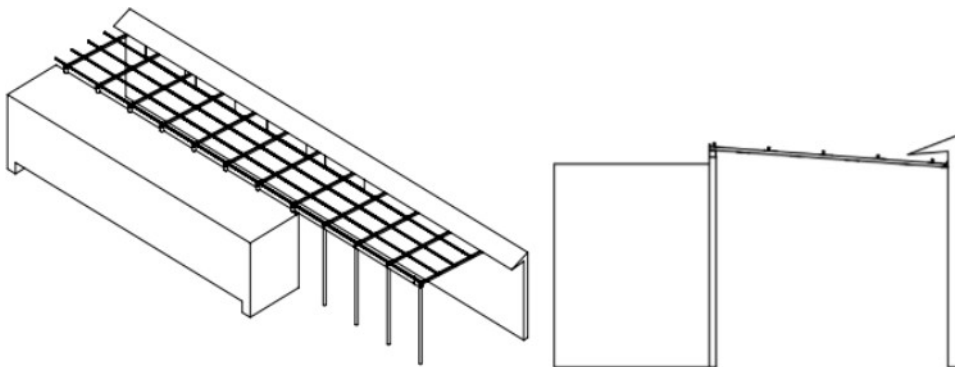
Desenho da estrutura de suporte para captação de água e placas fotovoltaicas (esq. perspectiva; dir. vista lateral da estrutura)
